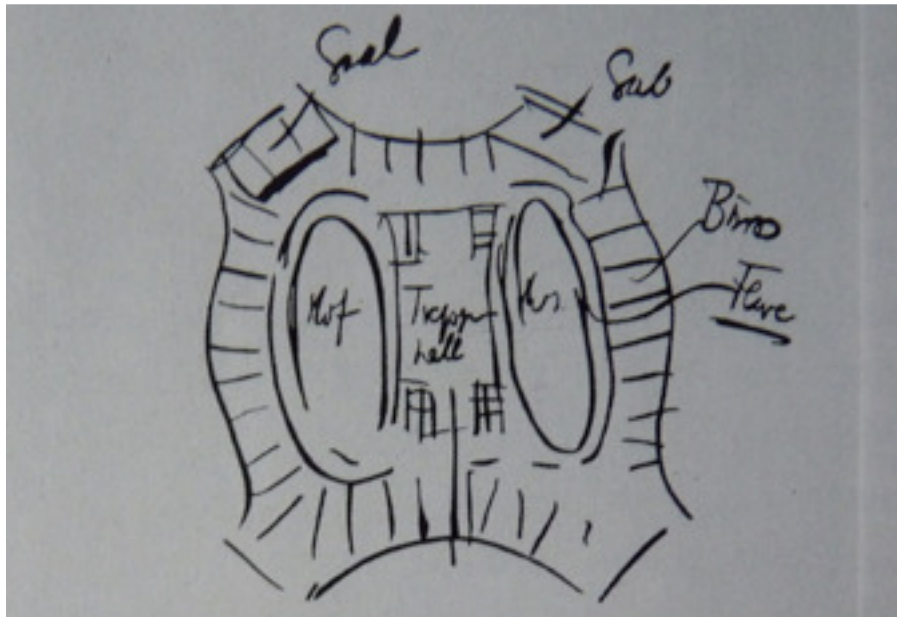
, Hans Poelzig, Grundrisskizze für die Dresdner Stadthalle, 1921.
